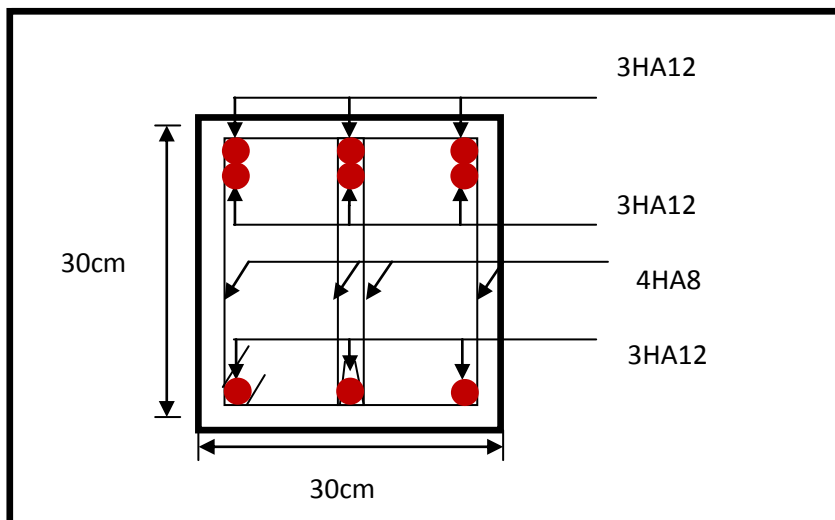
Ferrailage aux appuis d’une poutre secondaire
